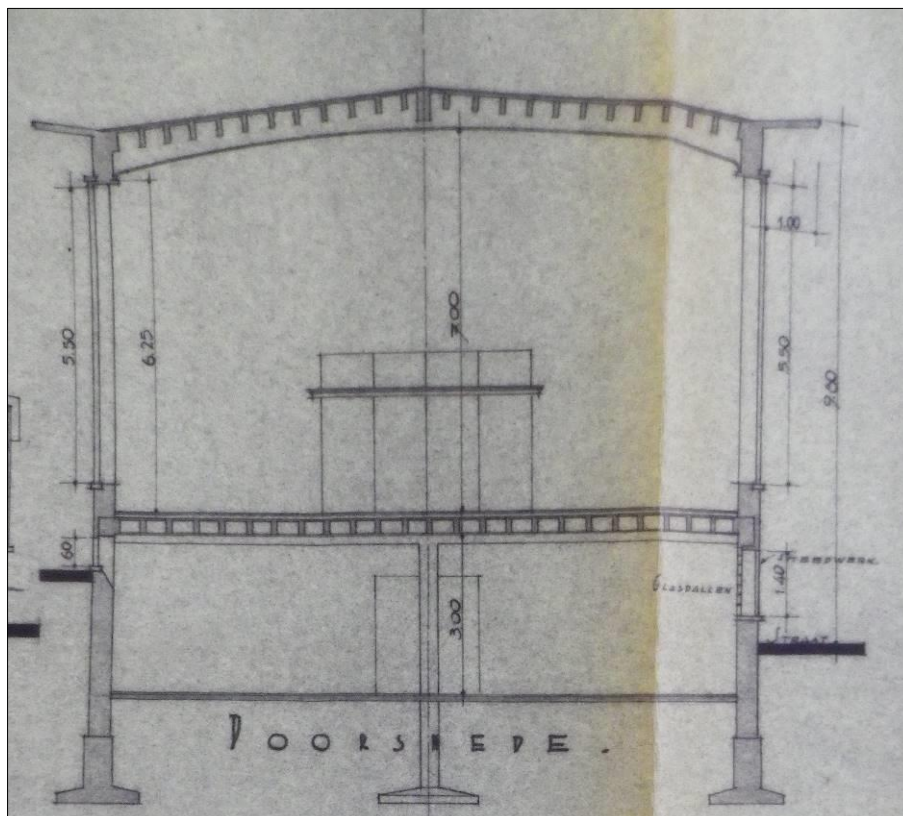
Plan met bestaande toestand in 1957. (RAL, archief Jos Stas, nr. 794)
